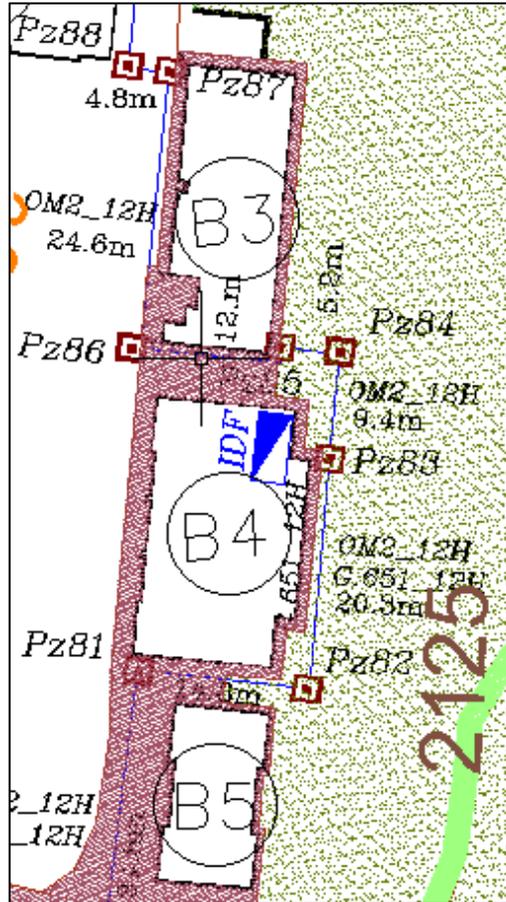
Planimetría del recorrido de fibra óptica existente bloques 3 y 4. (Autor, s.f.)
